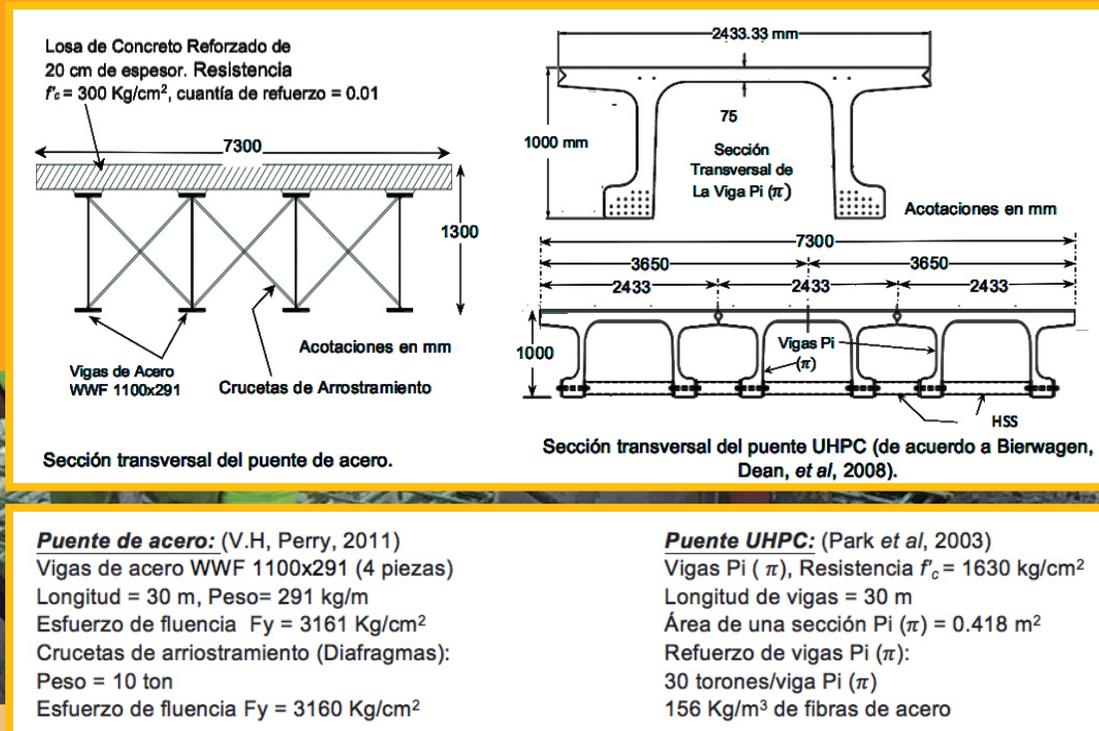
Sección transversal de puente de acero con losa in situ de concreto reforzado contra puente de concreto presforzado con vigas prefabricadas tipo Pi (π) utilizando UHPC.
